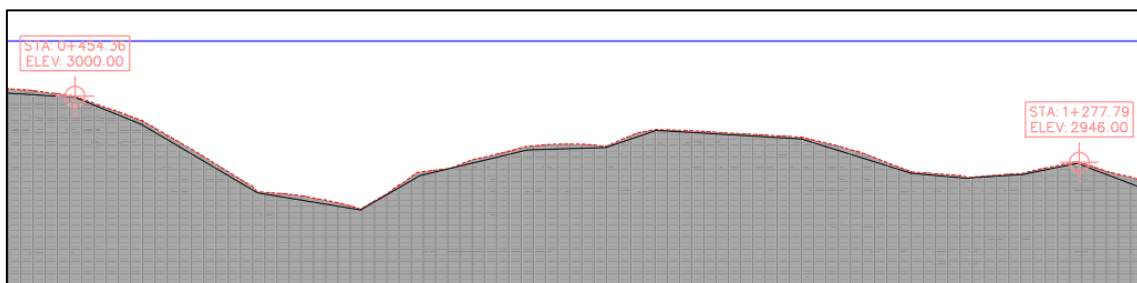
Planteamiento de mejora - Captación superficial vista corte
